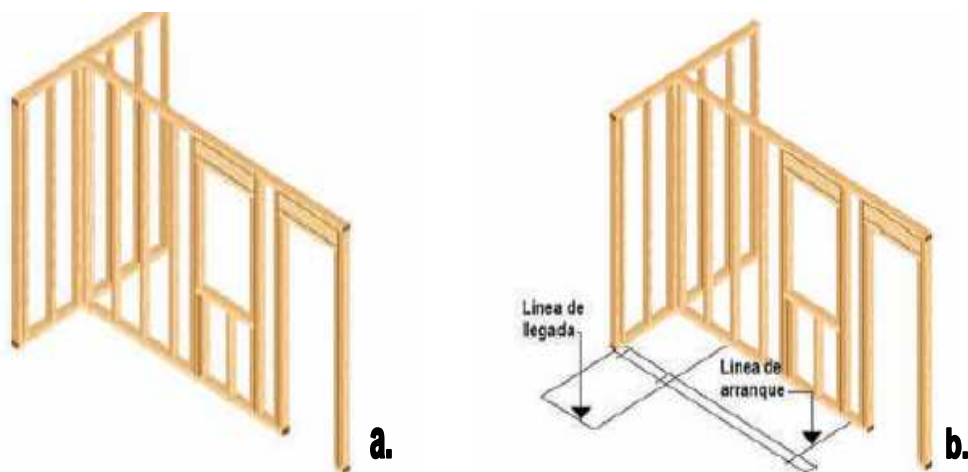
a. Tabiques de la estructura vistos desde el interior de la vivienda, en los cuales se apoyará la escalera b. Trazado de largo y ancho de la escalera en proyección horizontal
